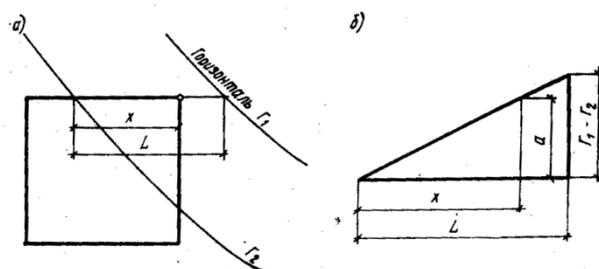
Схема для определения отметок рельефа: а - план; б – профиль
